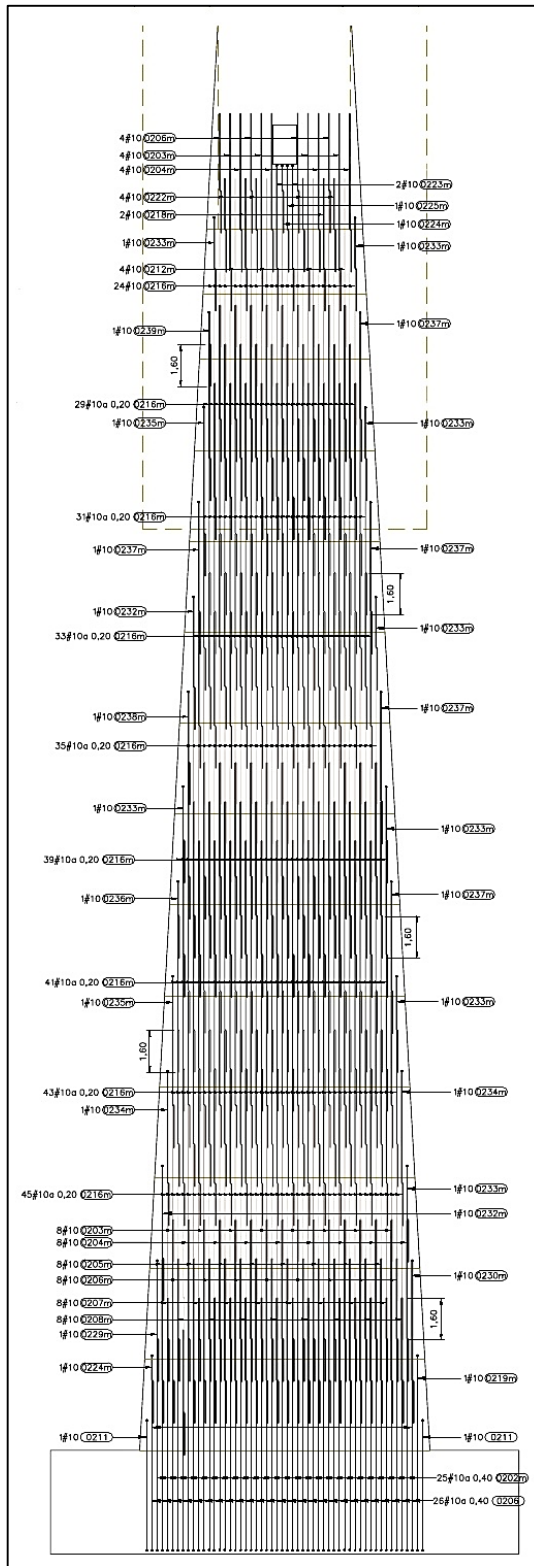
Refuerzo longitudinal para pilas en dirección transversal.
